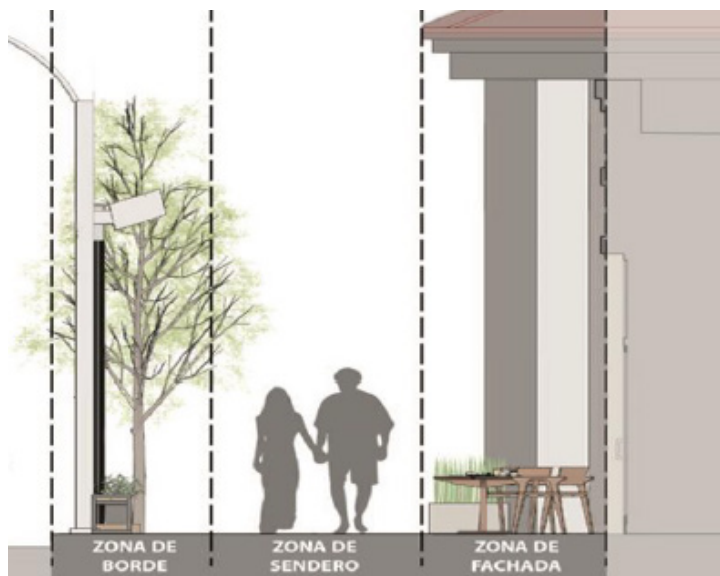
, TIPOS DE ZONA (IMPLAN).
